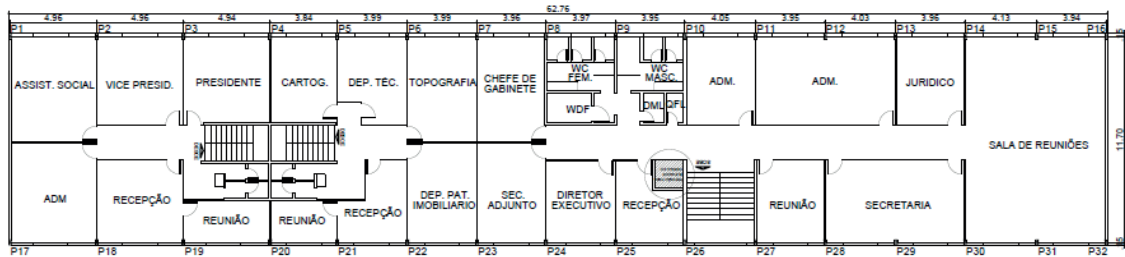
Pavimento Superior: distribuição dos pilares de concreto existentes (P) e painéis divisórios.
